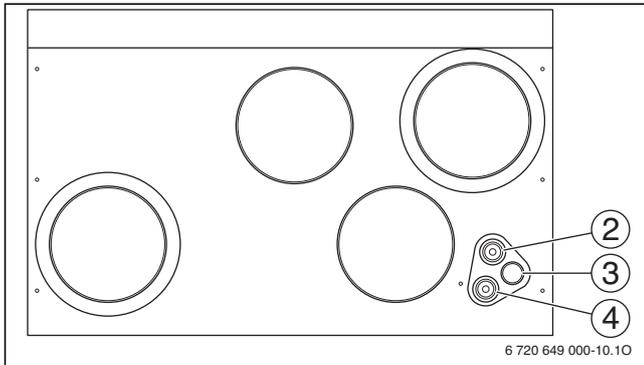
Geräteaufsicht LP 150-1 mit Kabeldurchführungen
